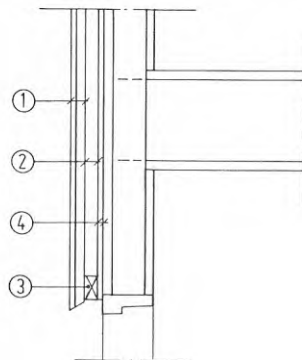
Ny träpanel som fasadbeklädnad på befintlig trästomme, tillhörande brandhärdig byggnad (med tilläggsisolering)
